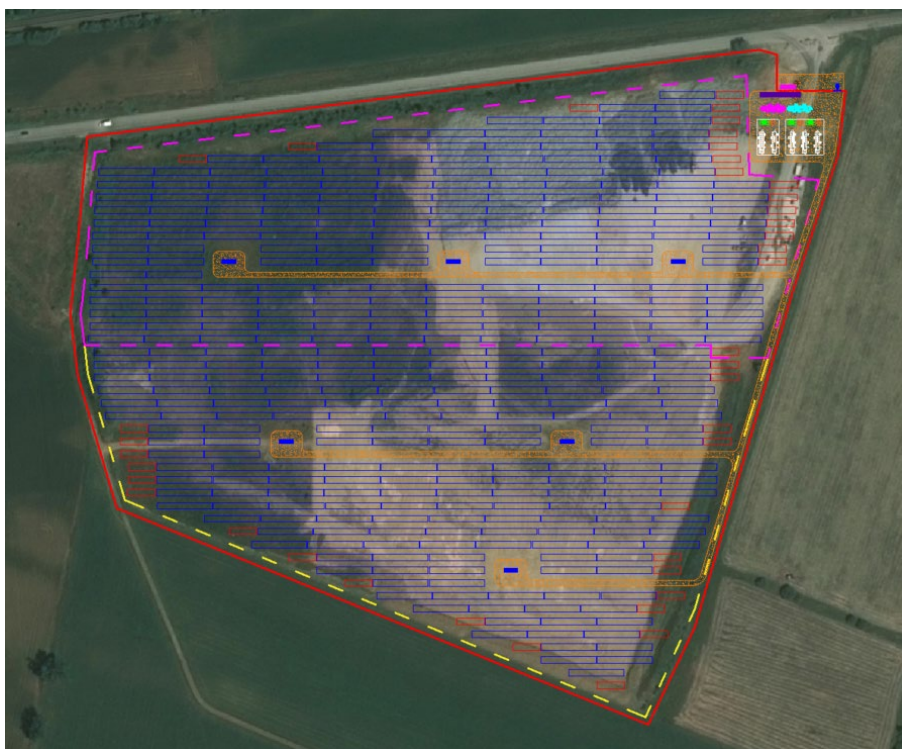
Layout di impianto con sovrapposizione su ortofoto, sottocampo "Guarasca". In magenta la demarcazione del Lotto A, in giallo la demarcazione del lotto B.
